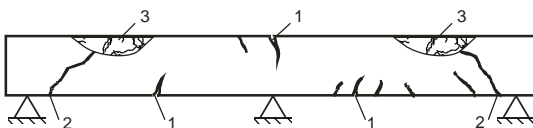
Характерные трещины в изгибаемых железобетонных элементах, работающих по балочной схеме:
